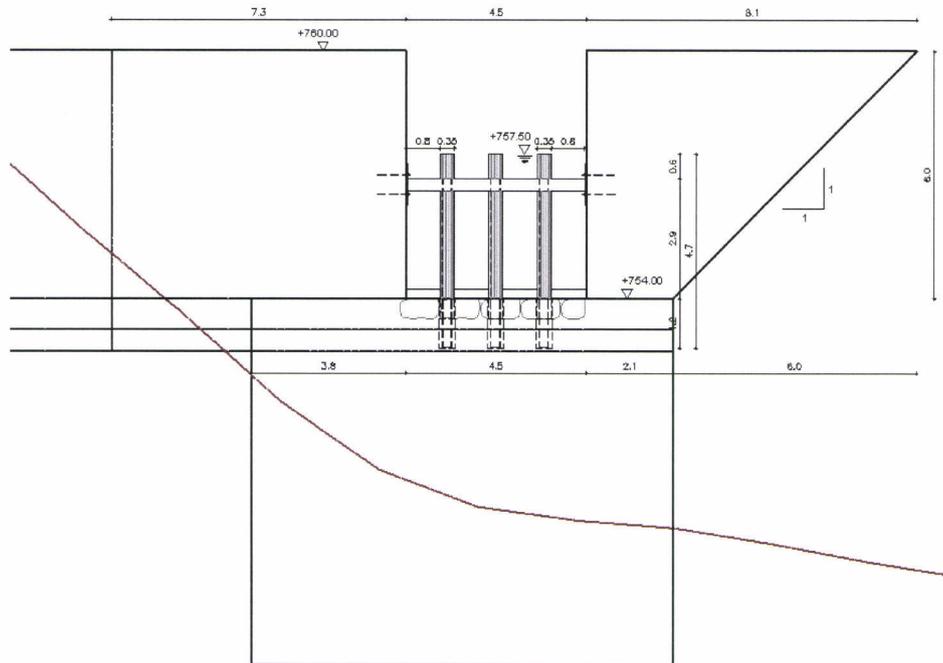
Prospetto della briglia con il filtro a pettine di progetto
